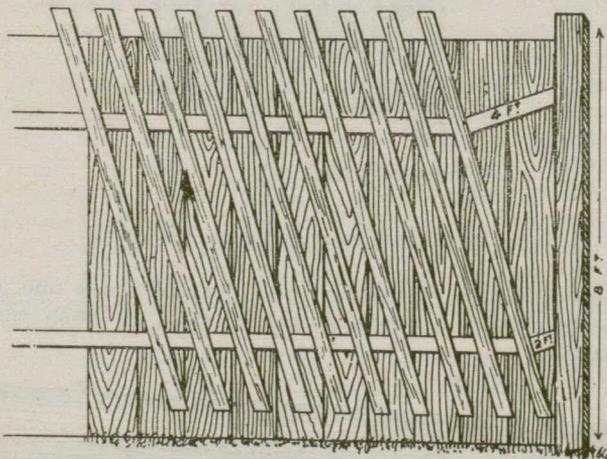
RÂTELIER POUR ENGRAISSEMENT EN PLEIN AIR.
